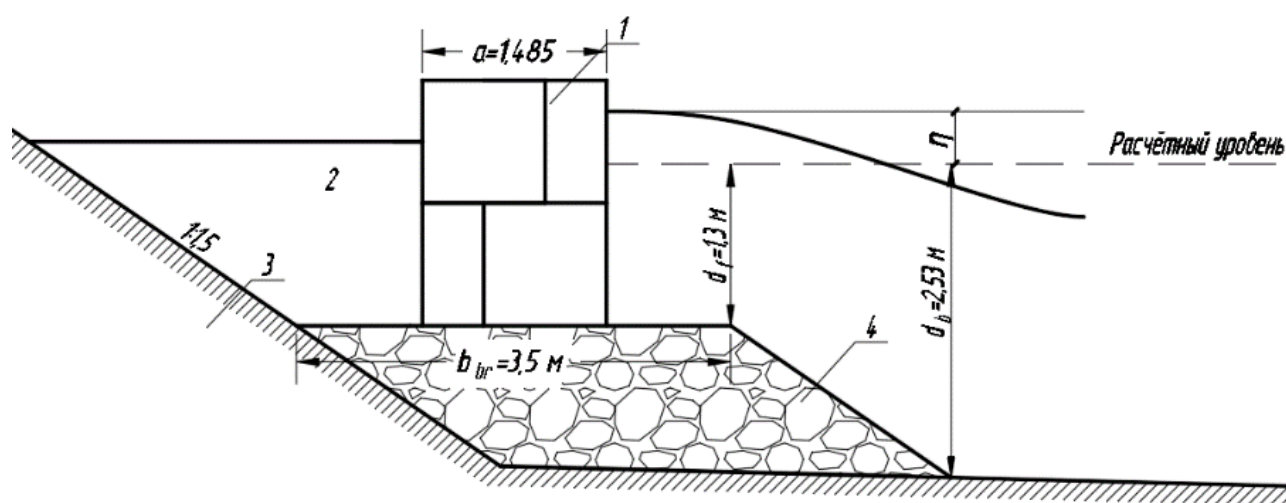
Расчетная схема укрепления из бетонных блоков:
